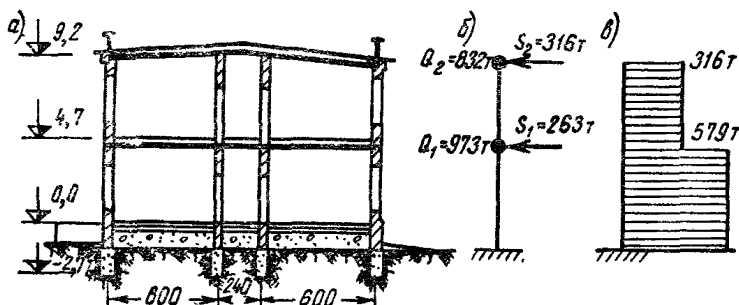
Конструктивная (а) и расчетная (б) схемы двухэтажного каменного здания и эпюра поперечных сил от сейсмической нагрузки (в)
